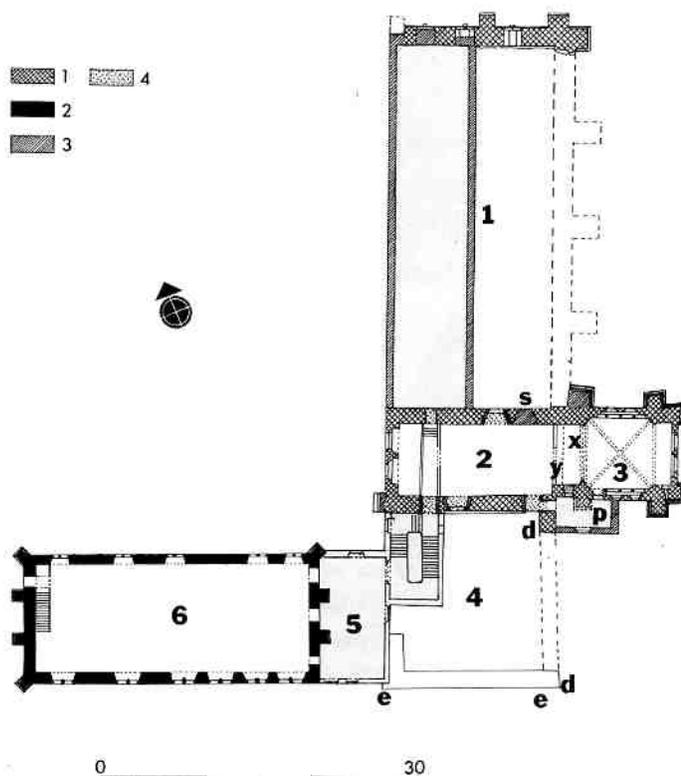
PLAN DU PALAIS AU PREMIER ÉTAGE, DANS SON ÉTAT EN 1963
